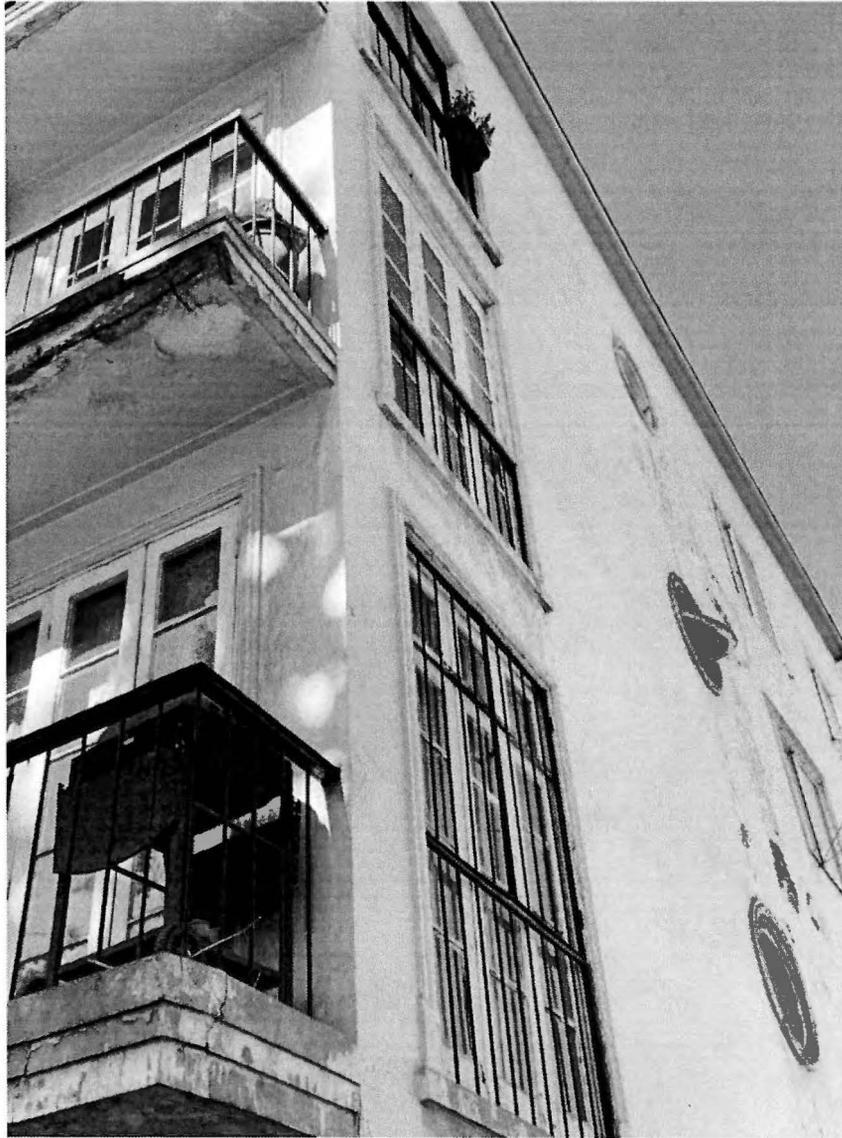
Desprendimiento de recubrimiento inferior de losas de balcones, fachada oriente.
